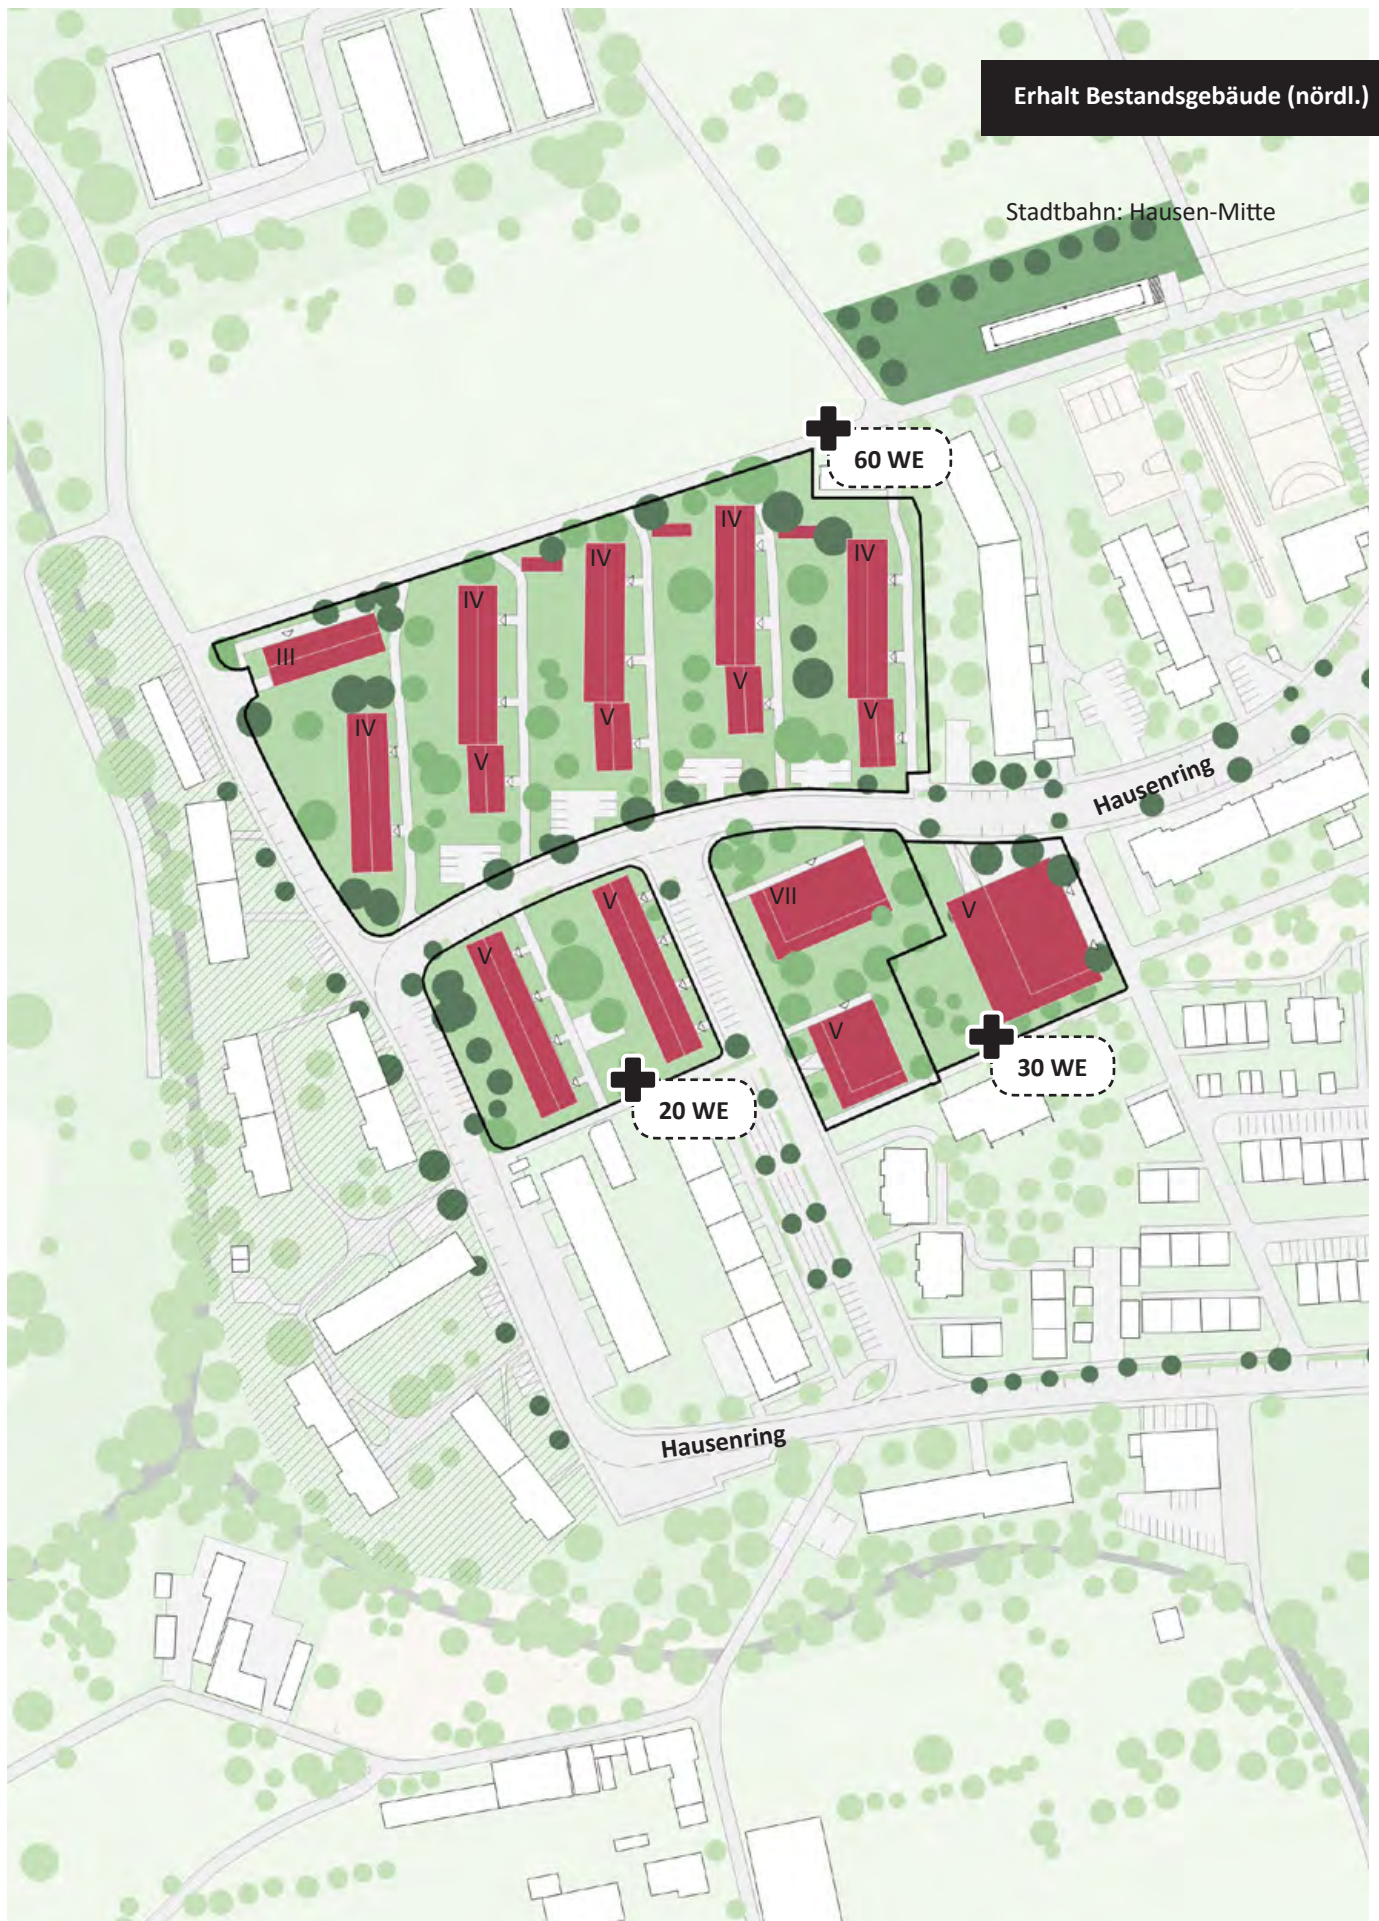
Lageplan der Bebauungsvariante zum Erhalt der bestehenden Zeilenbauten
